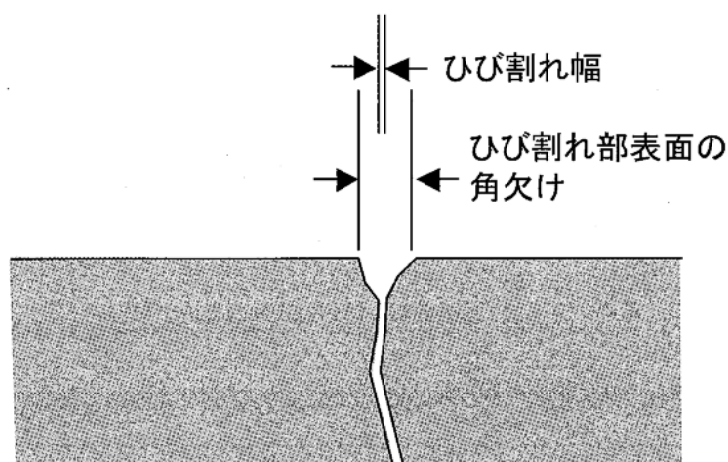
ひび割れ部の角欠けとひび割れ幅
